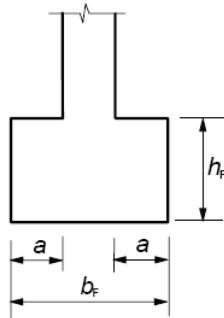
Unbewehrte Stützenfundamente; Bezeichnungen
